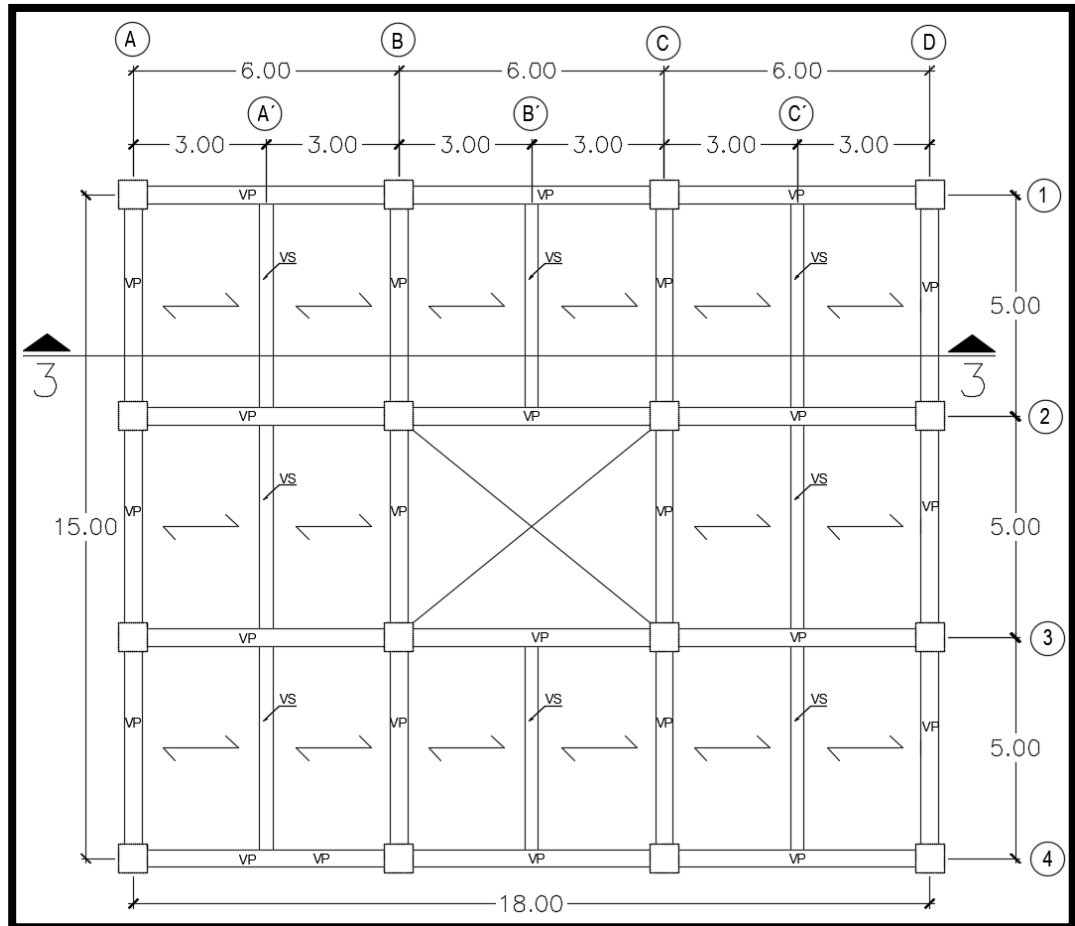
Planta de losa para el diseño como sistema de vigueta y bovedilla.
